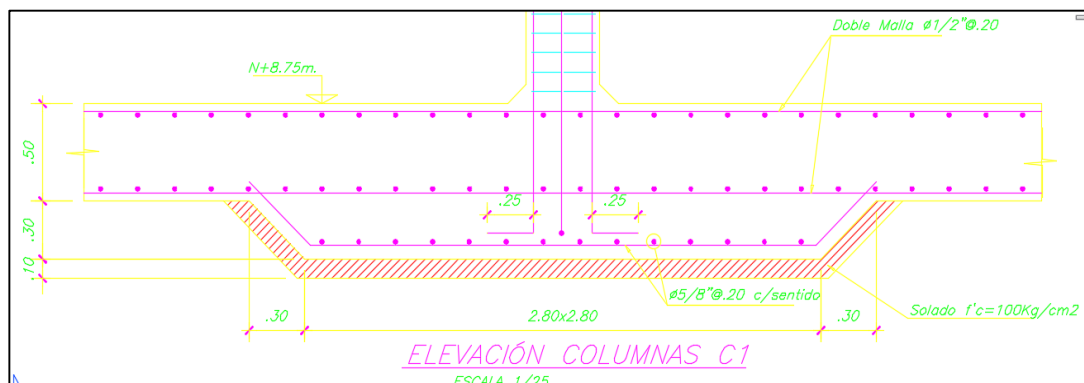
Detalle de armadura de acero en losa de cimentación y zapatas de columnas centrales en la cisterna de agua tratada.
